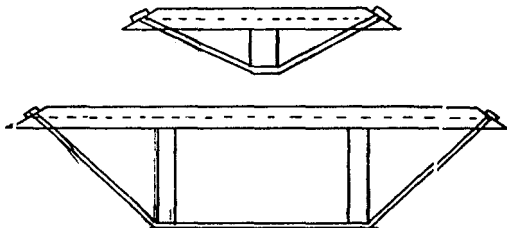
EJEMPLOS DE VIGAS ATIRANTADAS
